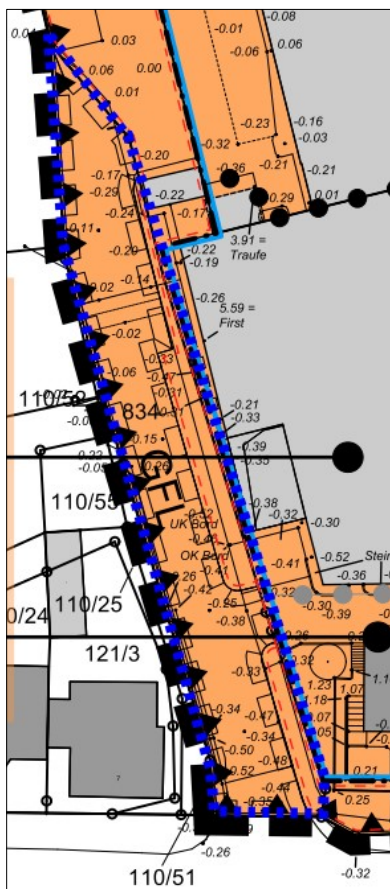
Markierung der Lage des Änderungsbereiches in Blau
